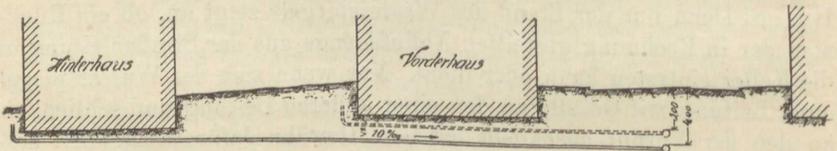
Entwässerung eines von der Straße abfallenden Grundstückes.
